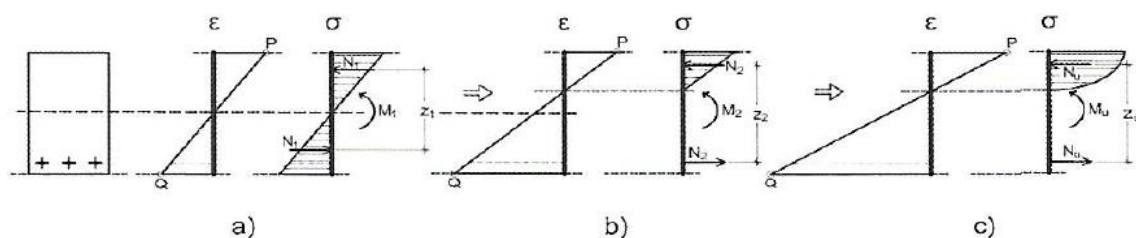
a) Secció no fissurada (I) b) Secció fissurada amb poca càrrega (IIa) c) Secció fissurada amb molta càrrega (IIb) [1]
